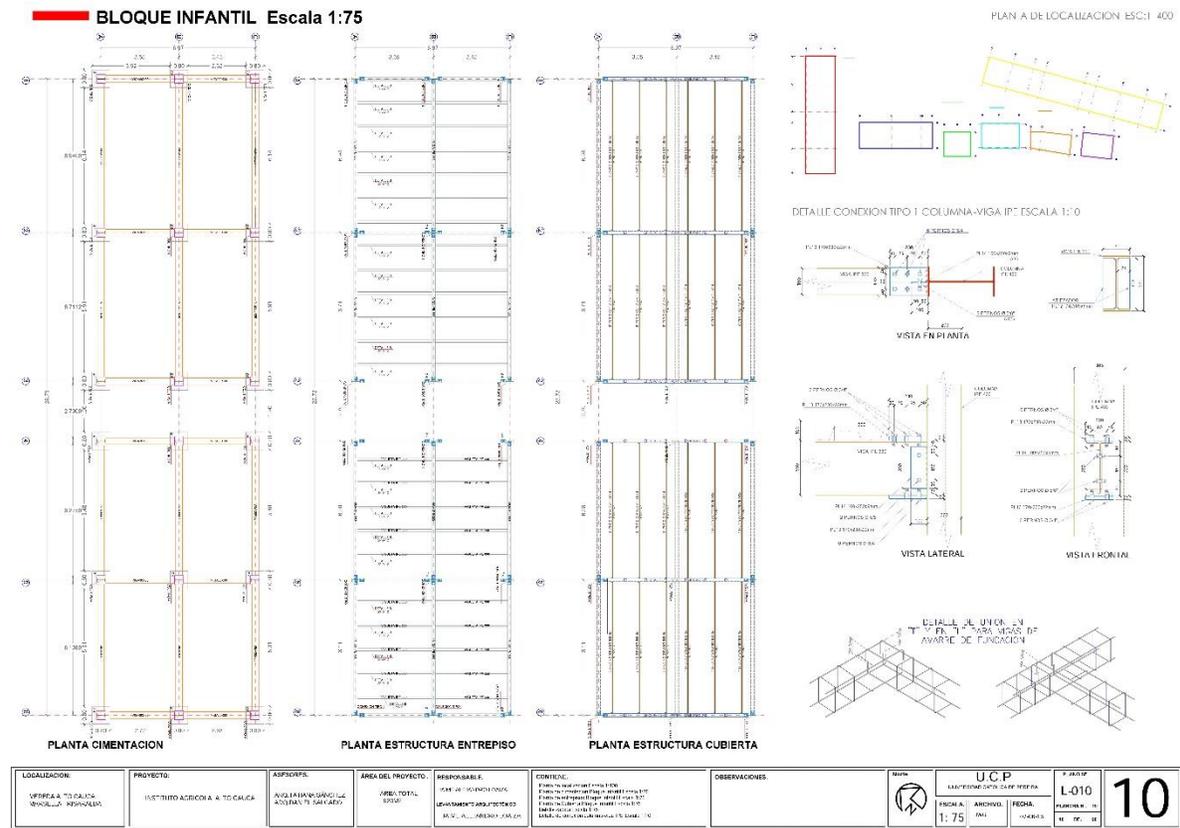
PLANOS: CIMENTACION, ESTRUCTURAL, ENTREPISO DE BLOQUE INFANTIL, DETALLES.
